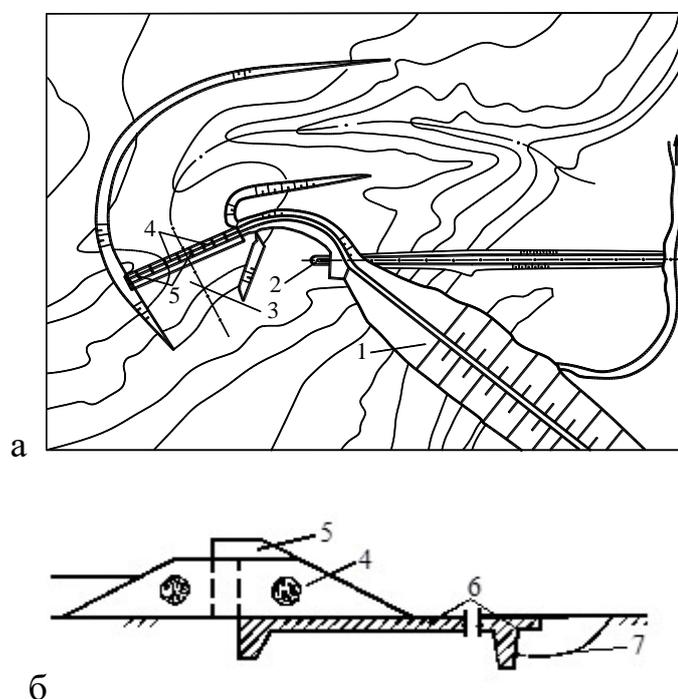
Схема гидроузла Бокс-Бьют (США) с основным ковшовым бетонным водосбросом и с резервным водосбросом типа размываемая («плавкая») вставка [32]: а – план; б – продольный разрез по размываемой вставке; 1 – грунтовая русловая плотина; 2 – основной водосброс; 3 – подводящий канал; 4 – размываемые вставки; 5 – отдельные быки; 6 – бетонный флютбет (ограничитель размыва) под размываемой вставкой; 7 – граница размыва
